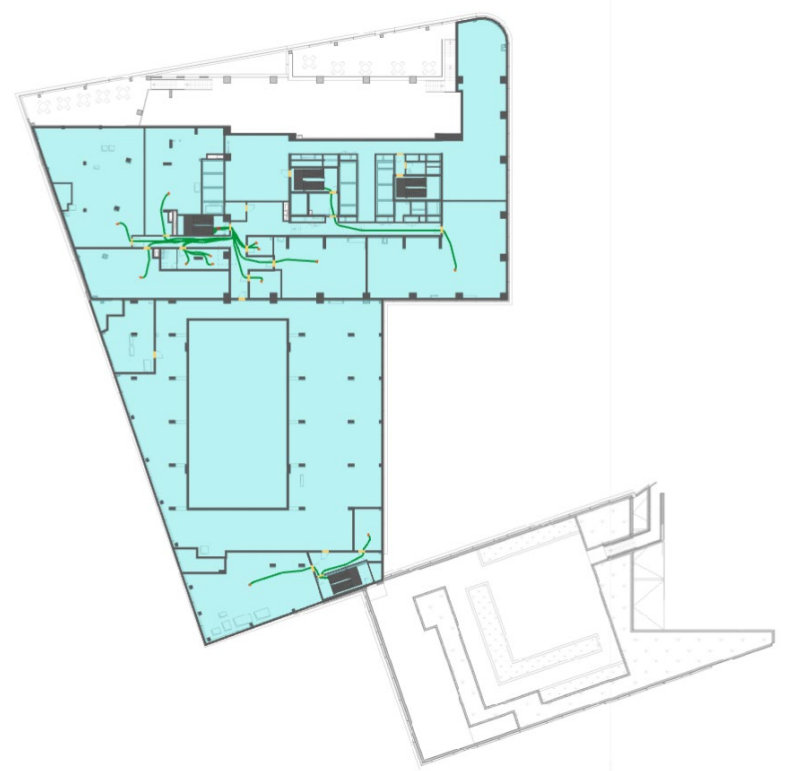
План 2-го этажа и нанесенная на него расчетная (принципиальная) схема эвакуации
